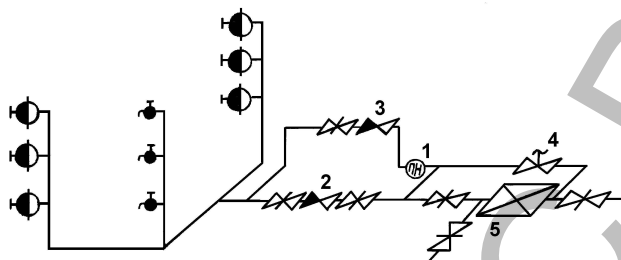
Схема водопровода с пожарными насосами-повысителями
